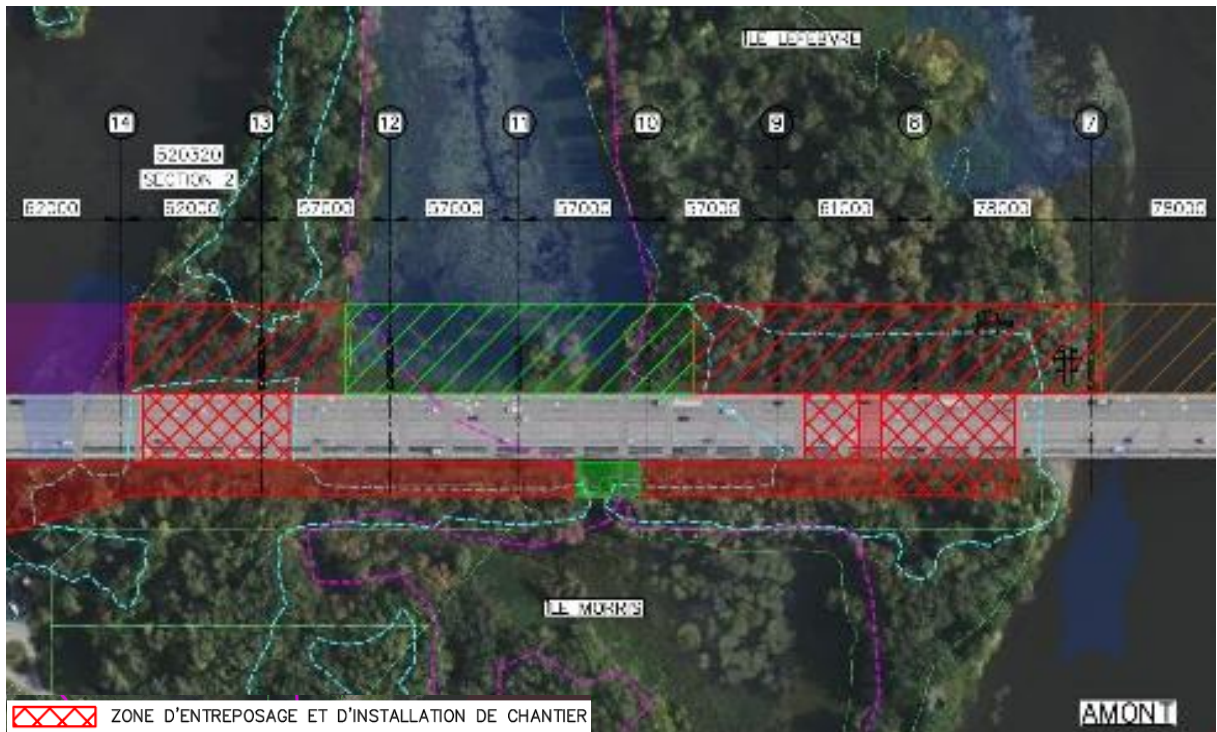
Zones d'entreposage et d'installation de chantier sur les îles Morris et Lefebvre
